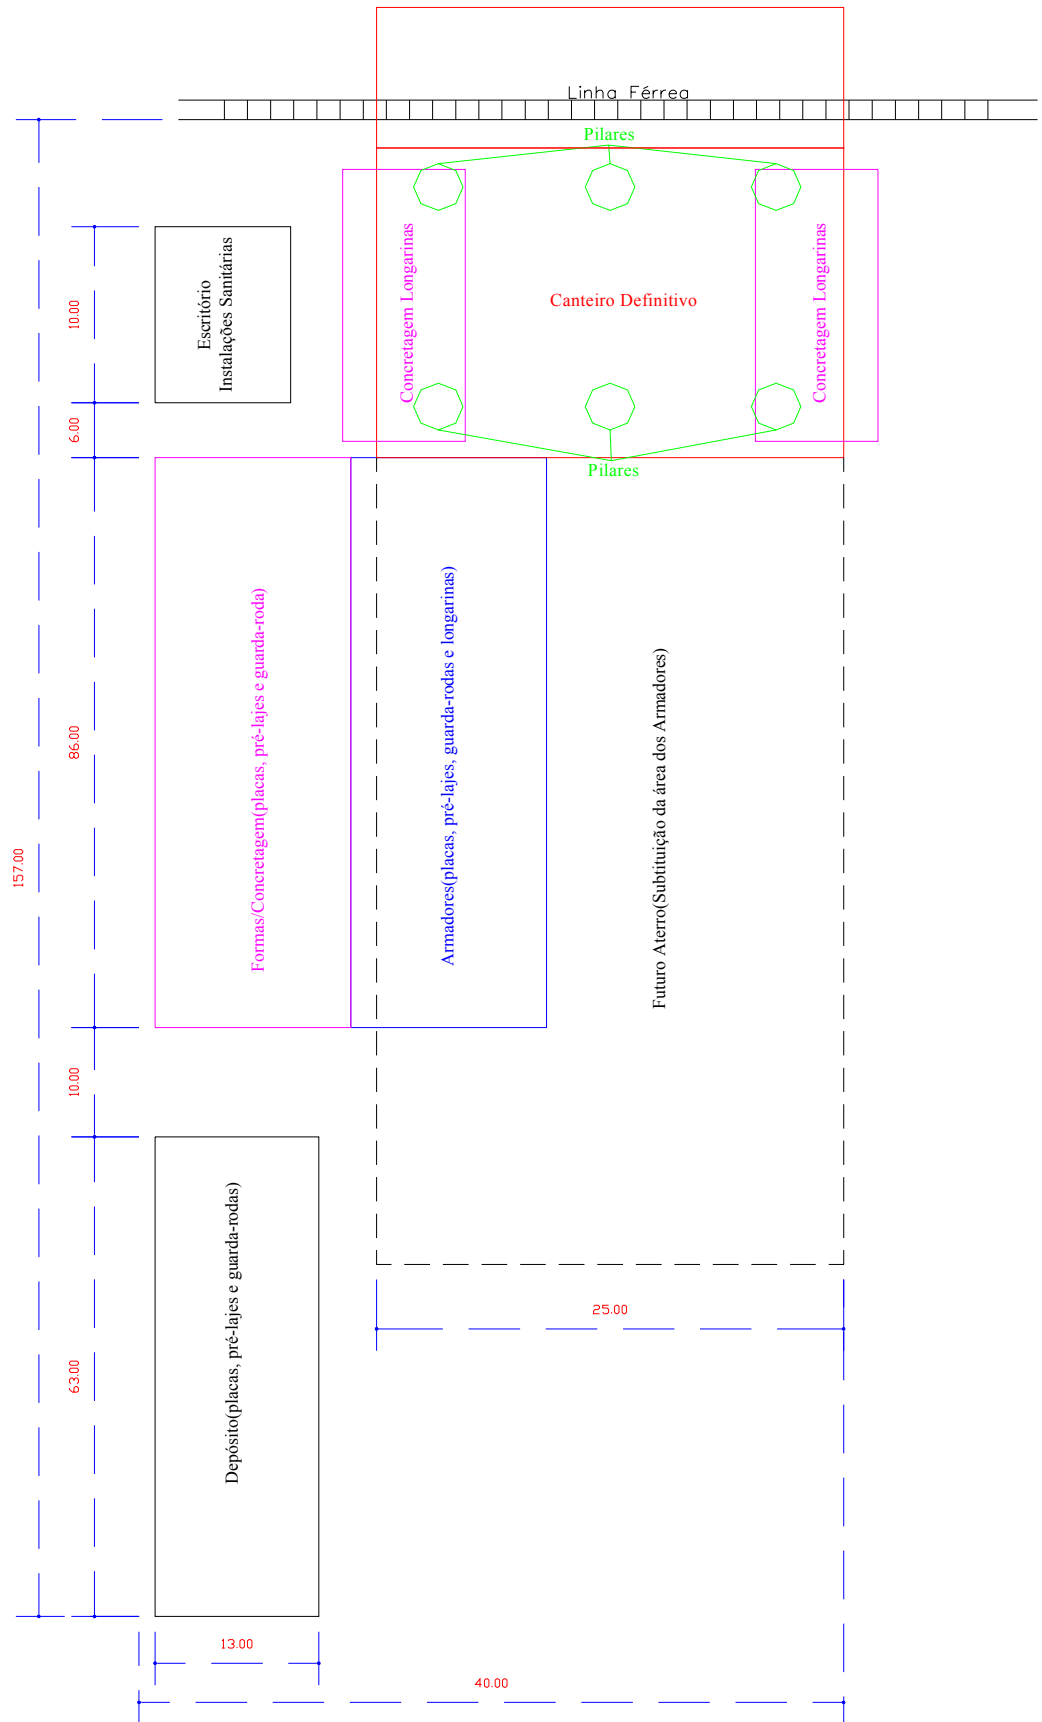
Lay-out do canteiro – (cotas em metro)
